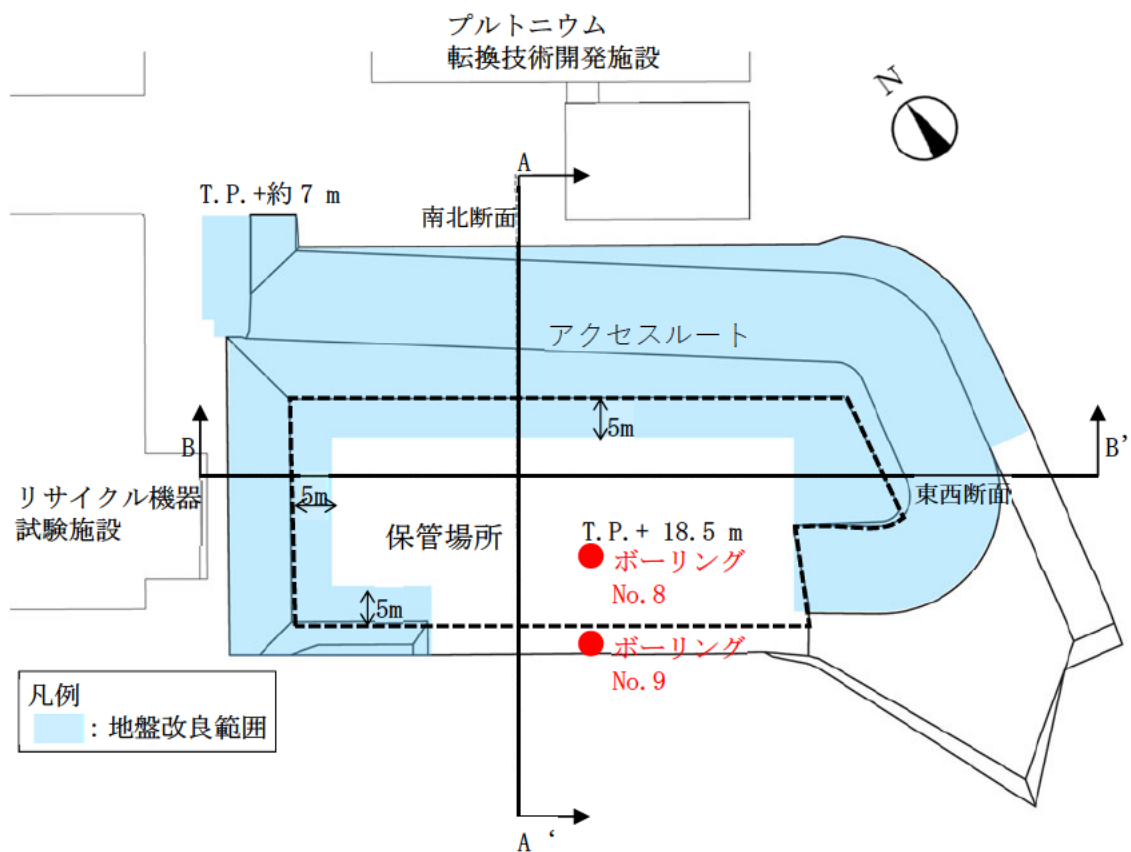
地盤改良範囲の平面図(図中赤丸印はボーリング調査位置を示す。)
